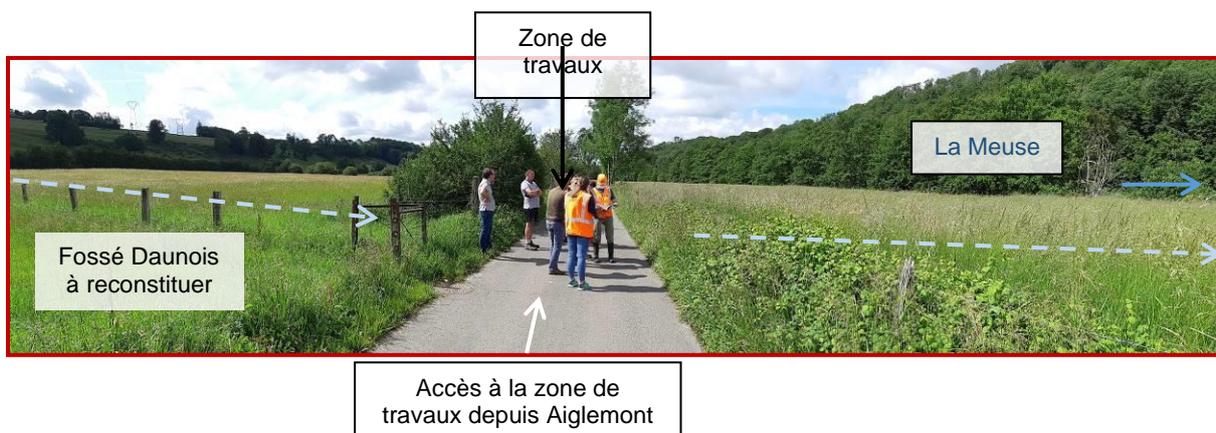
/06/2020 : accès à la zone de travaux pour la traversée de la route communale menant d'Aiglemont à Charleville-Mézières
